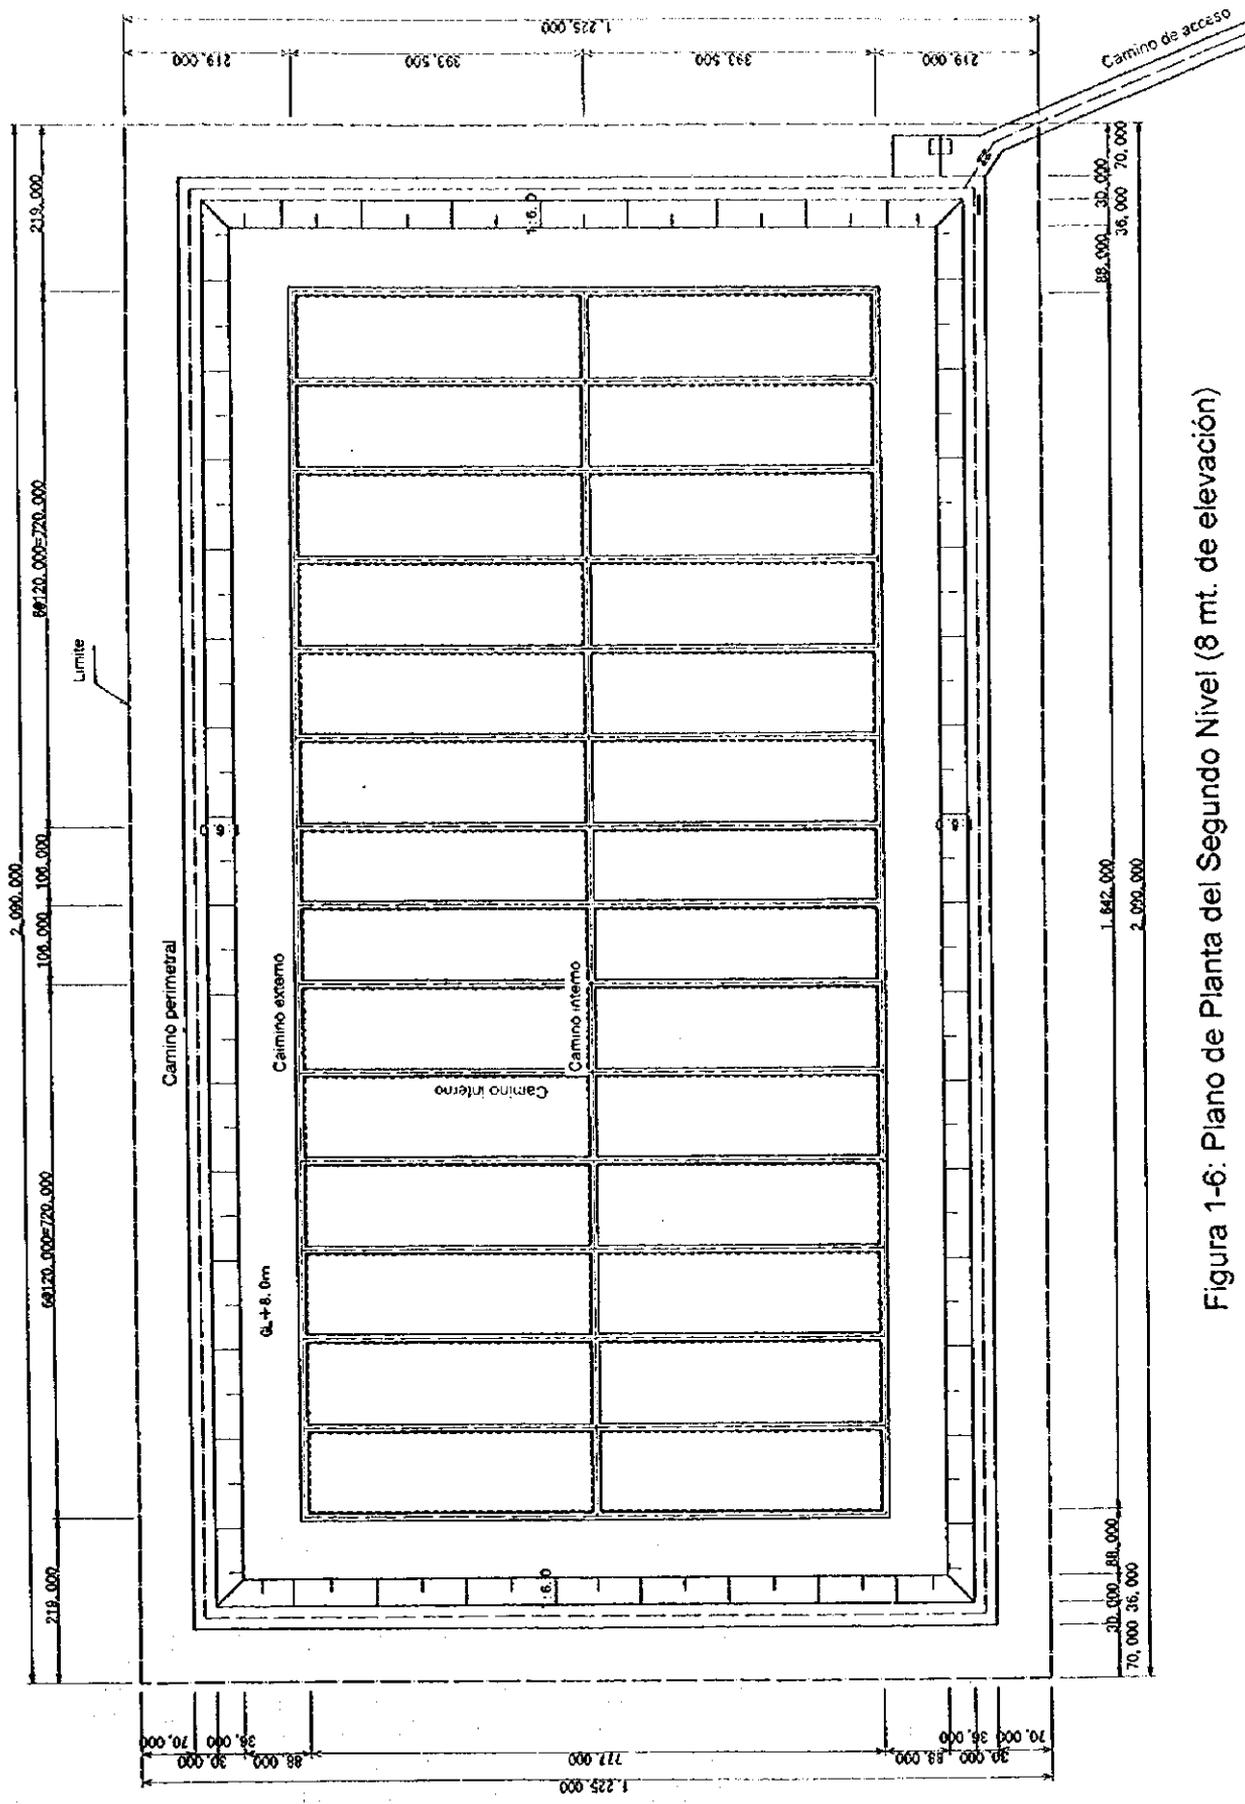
Plano de Planta del Segundo Nivel (8 mt. de elevación)
